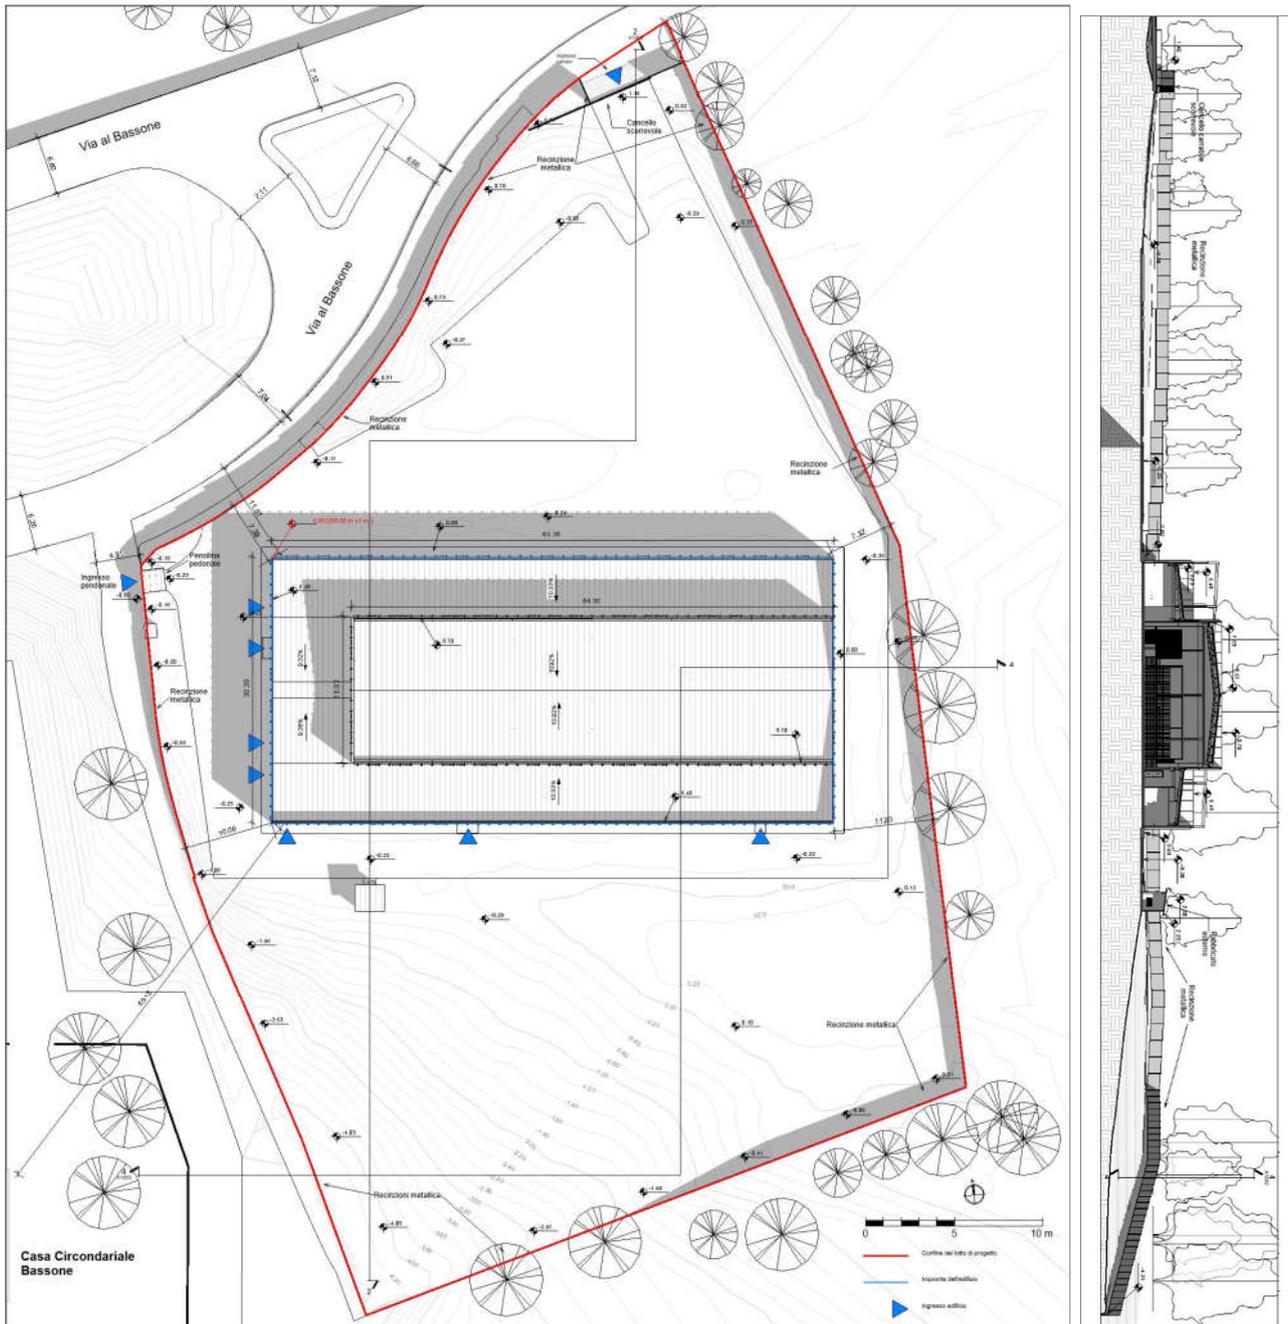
Planimetria e sezione territoriale del lotto di progetto – definizione dei limiti dell’ambito di intervento – Fuori scala
